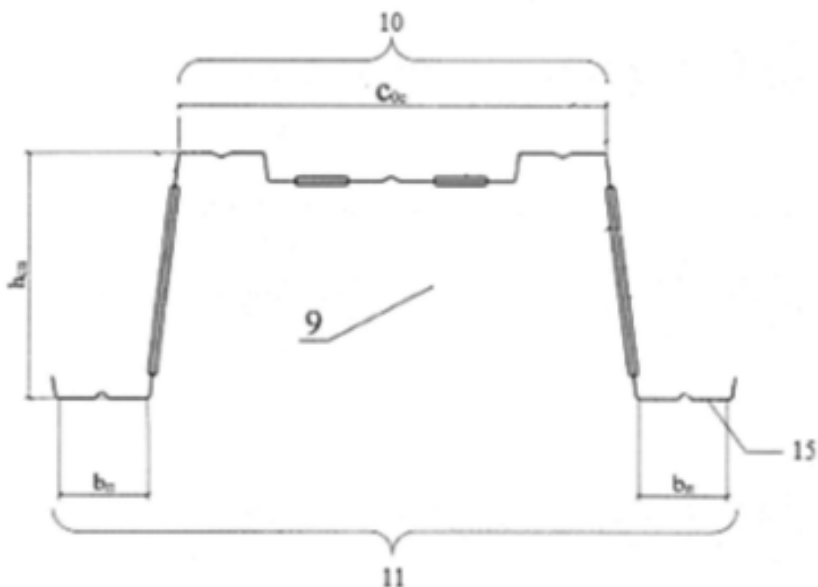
Поперечное сечение отдельного опалубочного элемента формователя [4], где: 9 – отдельный опалубочный элемент, 10 – верхнее основание незамкнутой трапеции, 11 – нижнее основание незамкнутой трапеции, 15 – отбортовка
